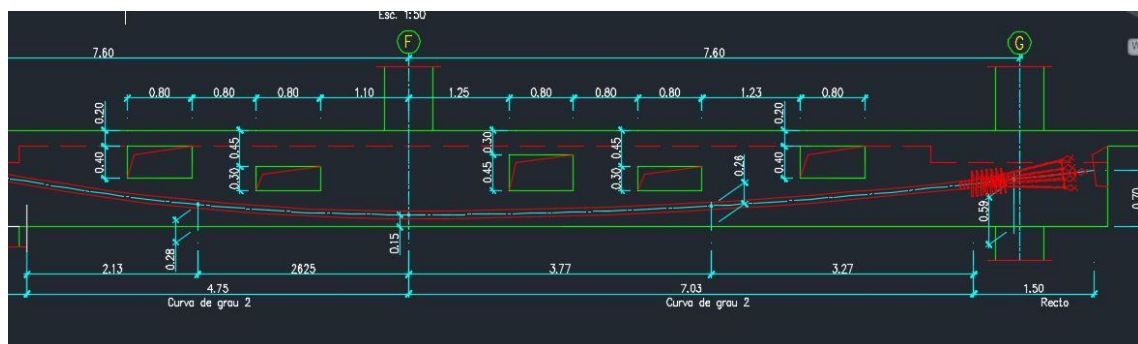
Viga 5 e traçado do cabo correspondente 6 e 7
